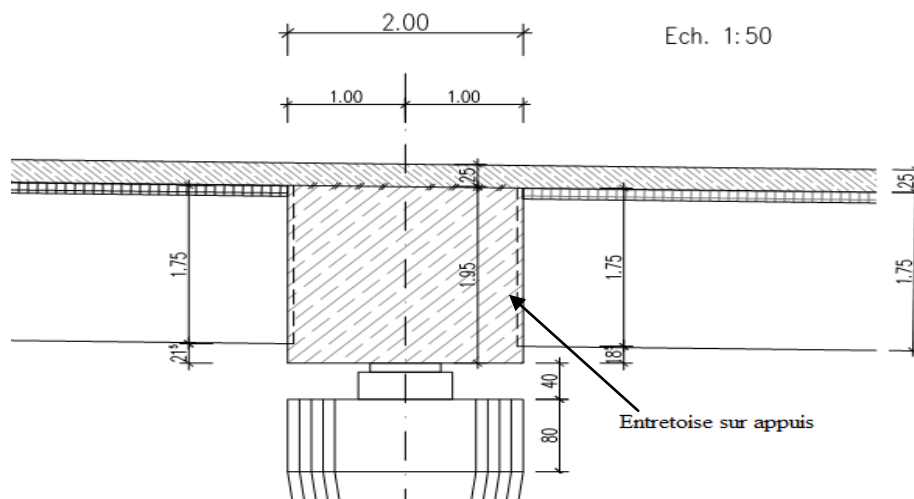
Coupe longitudinale de l'entretoise sur pile.
